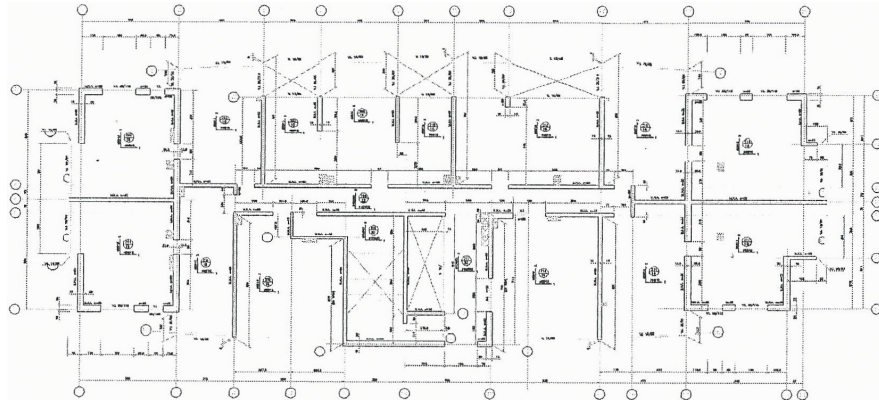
Planta Estructural Edificio Quinta Avenida
